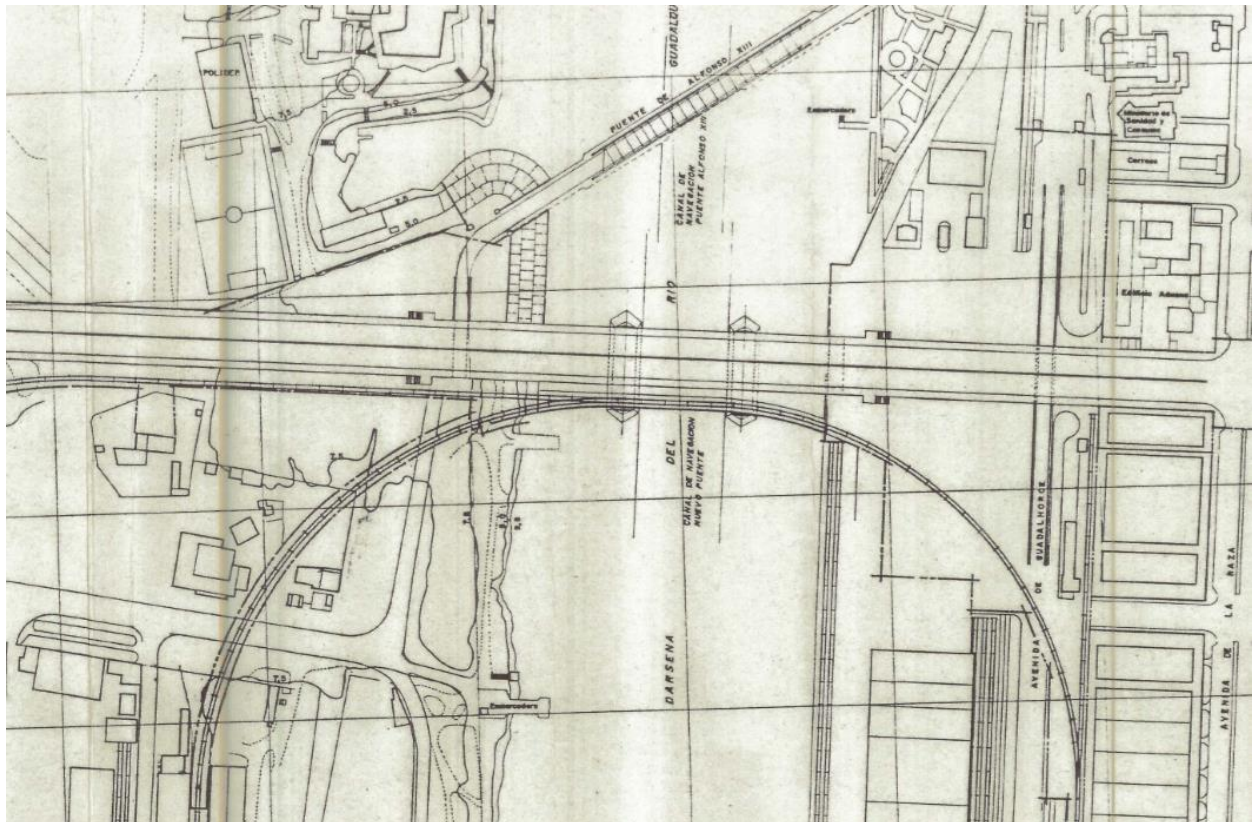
Planta general del proyecto. Fuente: Ayto. de Sevilla. Gerencia de Urbanismo.
